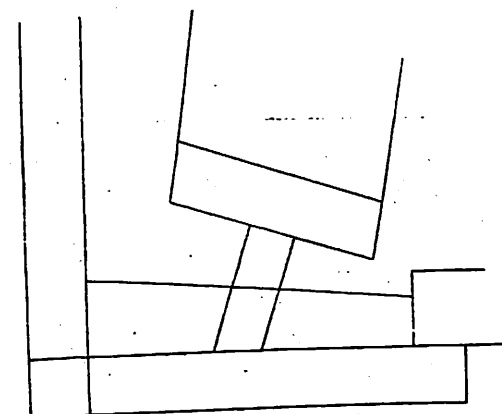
Pianta rilevante la posizione asimmetrica della chiesa nei confronti del resto delle costruzioni.
